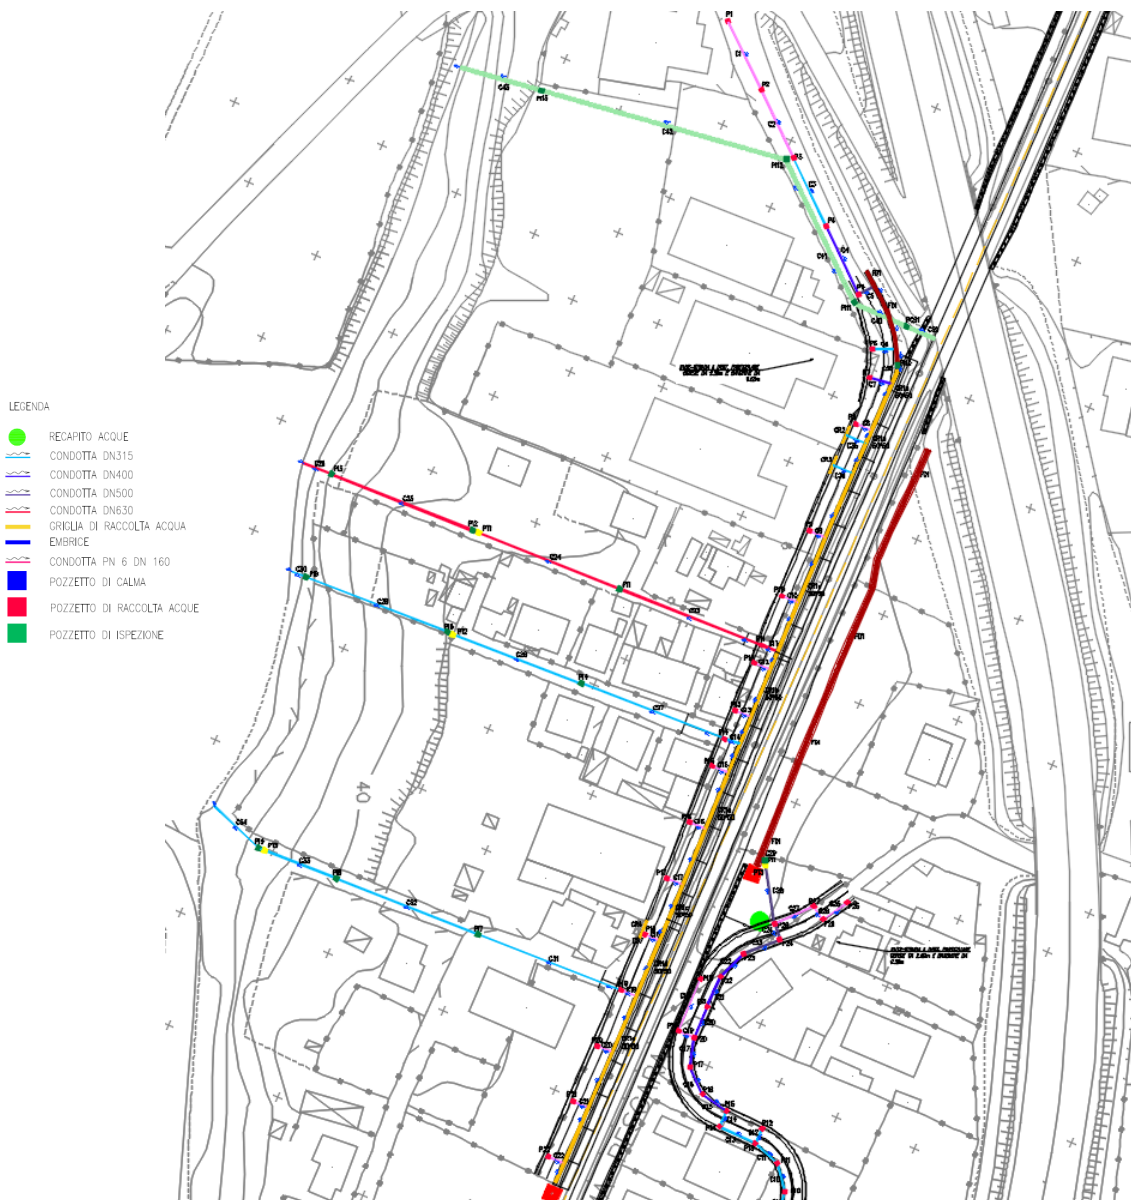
Stralcio planimetrico della rete di drenaggio Viabilità NV32
